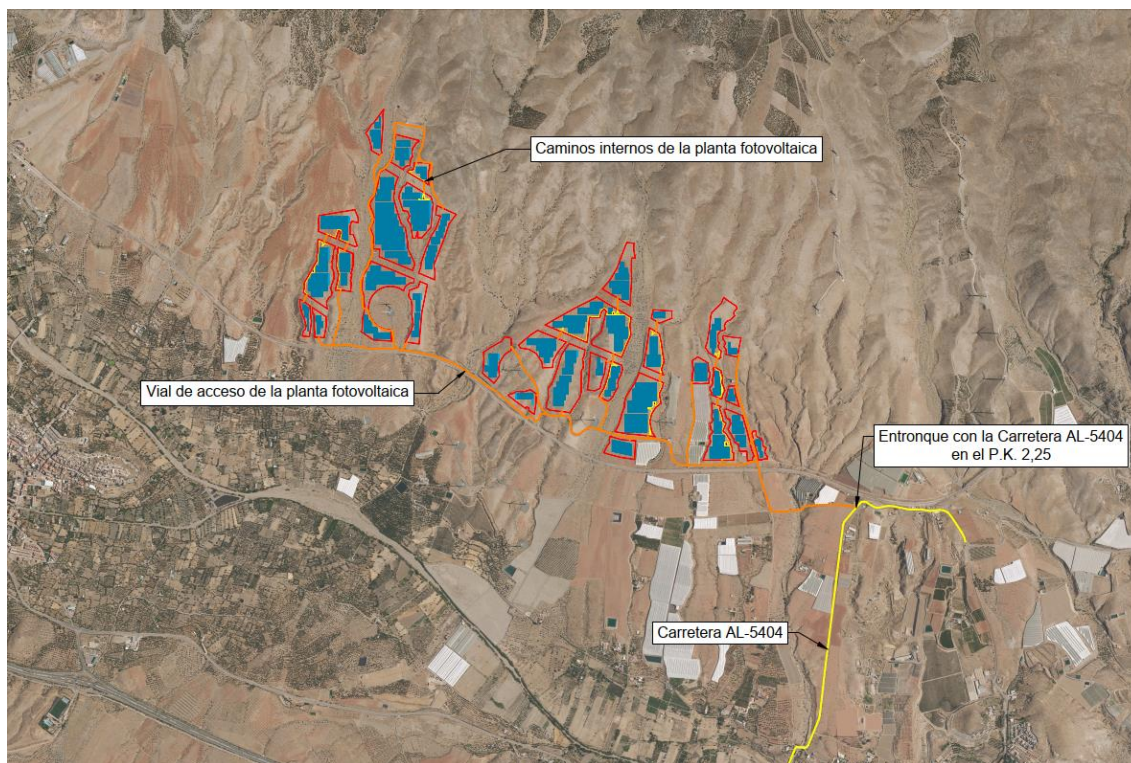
Detalle de acceso y caminos internos de la planta fotovoltaica.
